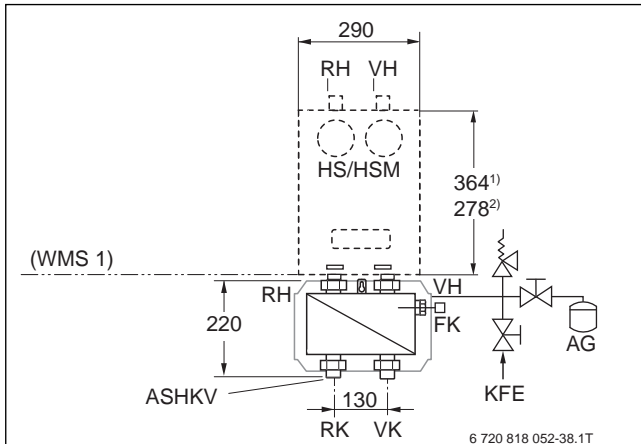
Abmessungen Anschluss-Set Wärmetauscher Systemtrennung mit Heizkreis-Set (Maße in mm)
